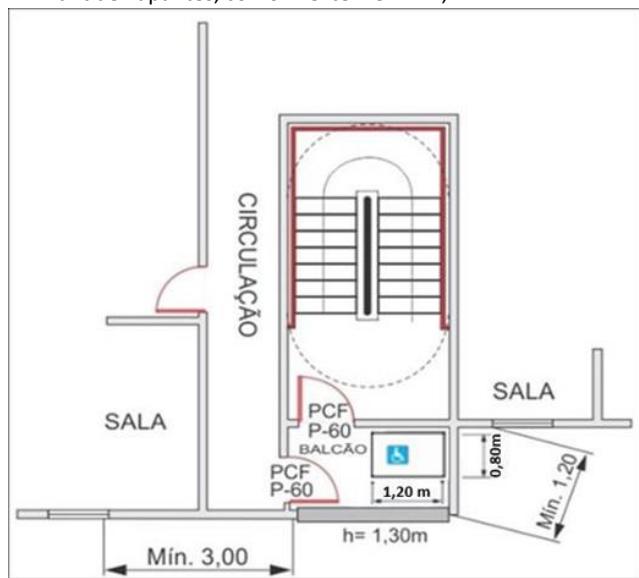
Escada enclausurada do tipo PF ventilada por balcão.
